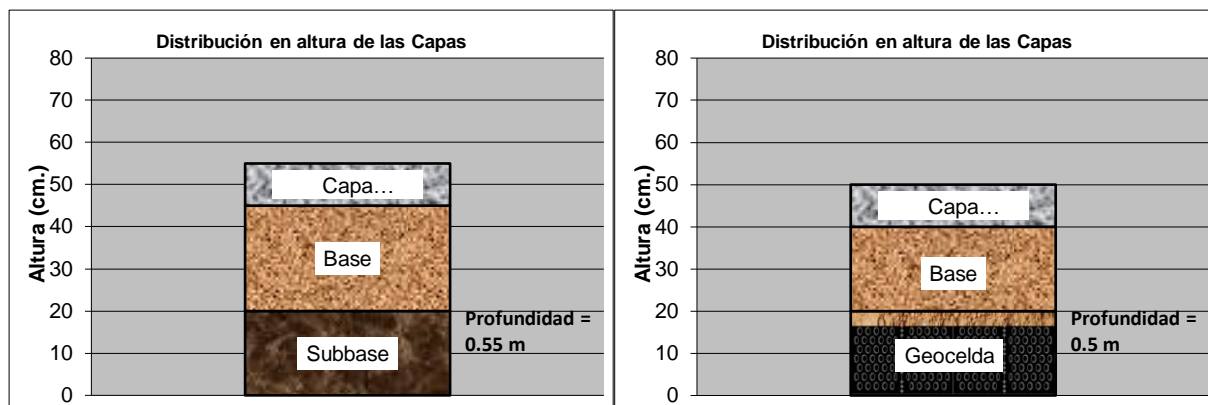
Espesores del pavimento sin reforzar y reforzado con geoceladas para una vía colectora.
